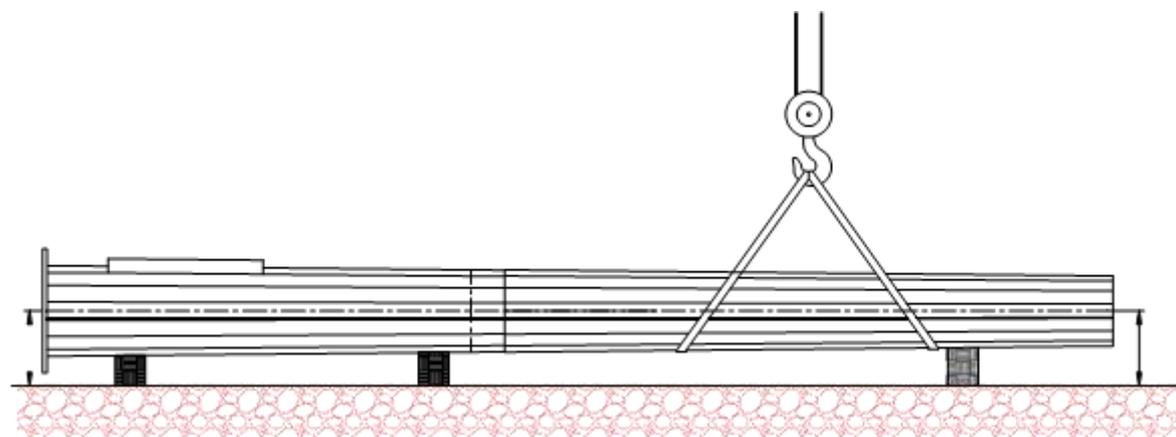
Установка нижнего первого элемента на подкладках
